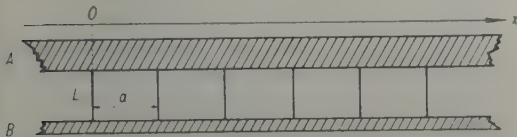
Schéma d'un plancher avec plafond suspendu.
